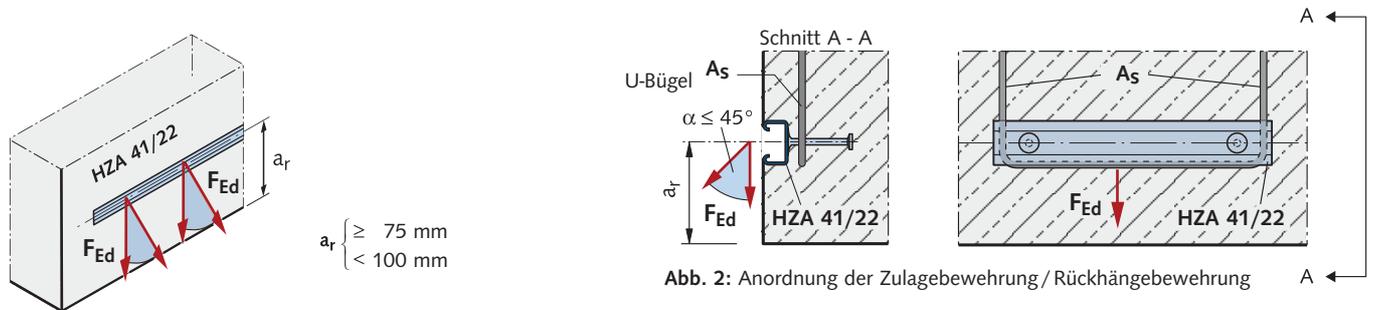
Anordnung der Zulagebewehrung/Rückhängebewehrung
